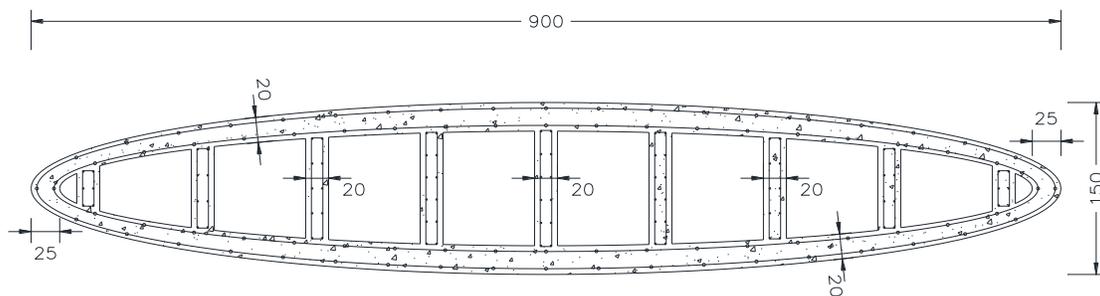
Sección de pilas No. 2, 3 y 4.
